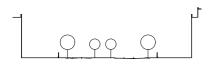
SECCIÓN DE BULEVAR CON ANDÉN CENTRAL (ver anexo1, ficha 4.2)
